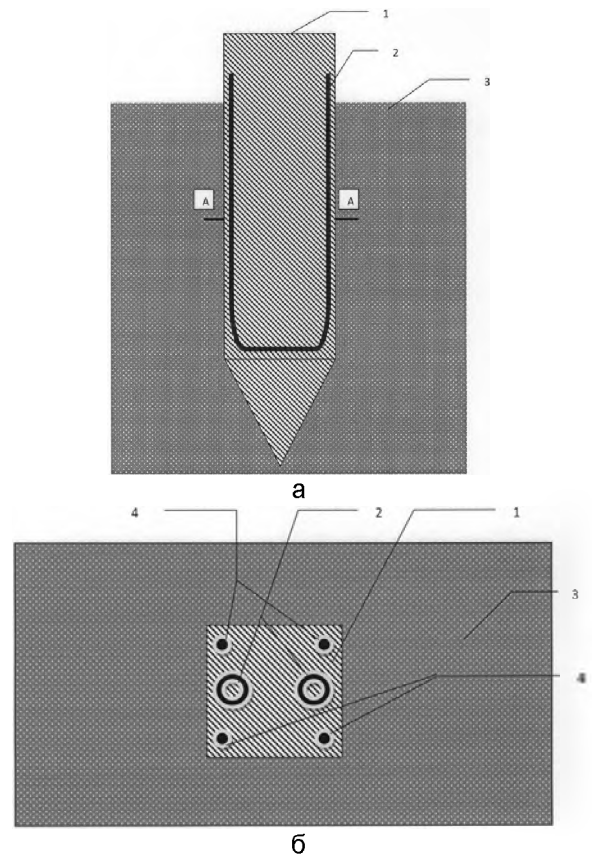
Фундаментна паля з вбудованим теплообмінником: а – вертикальний вистовий переріз палі; б – горизонтальний переріз палі в площині А-А
